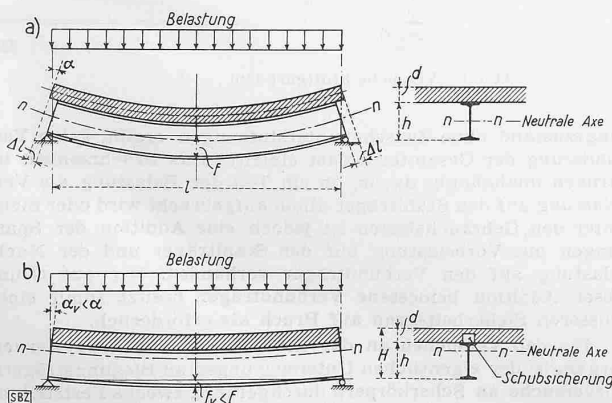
a) Stahlträger ohne Verbindung mit der Betonplatte
